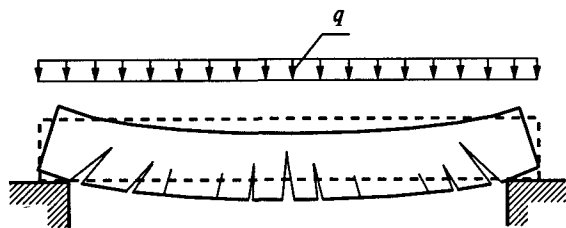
Схема разрушения железобетонной балки (арматура условно не показана)
